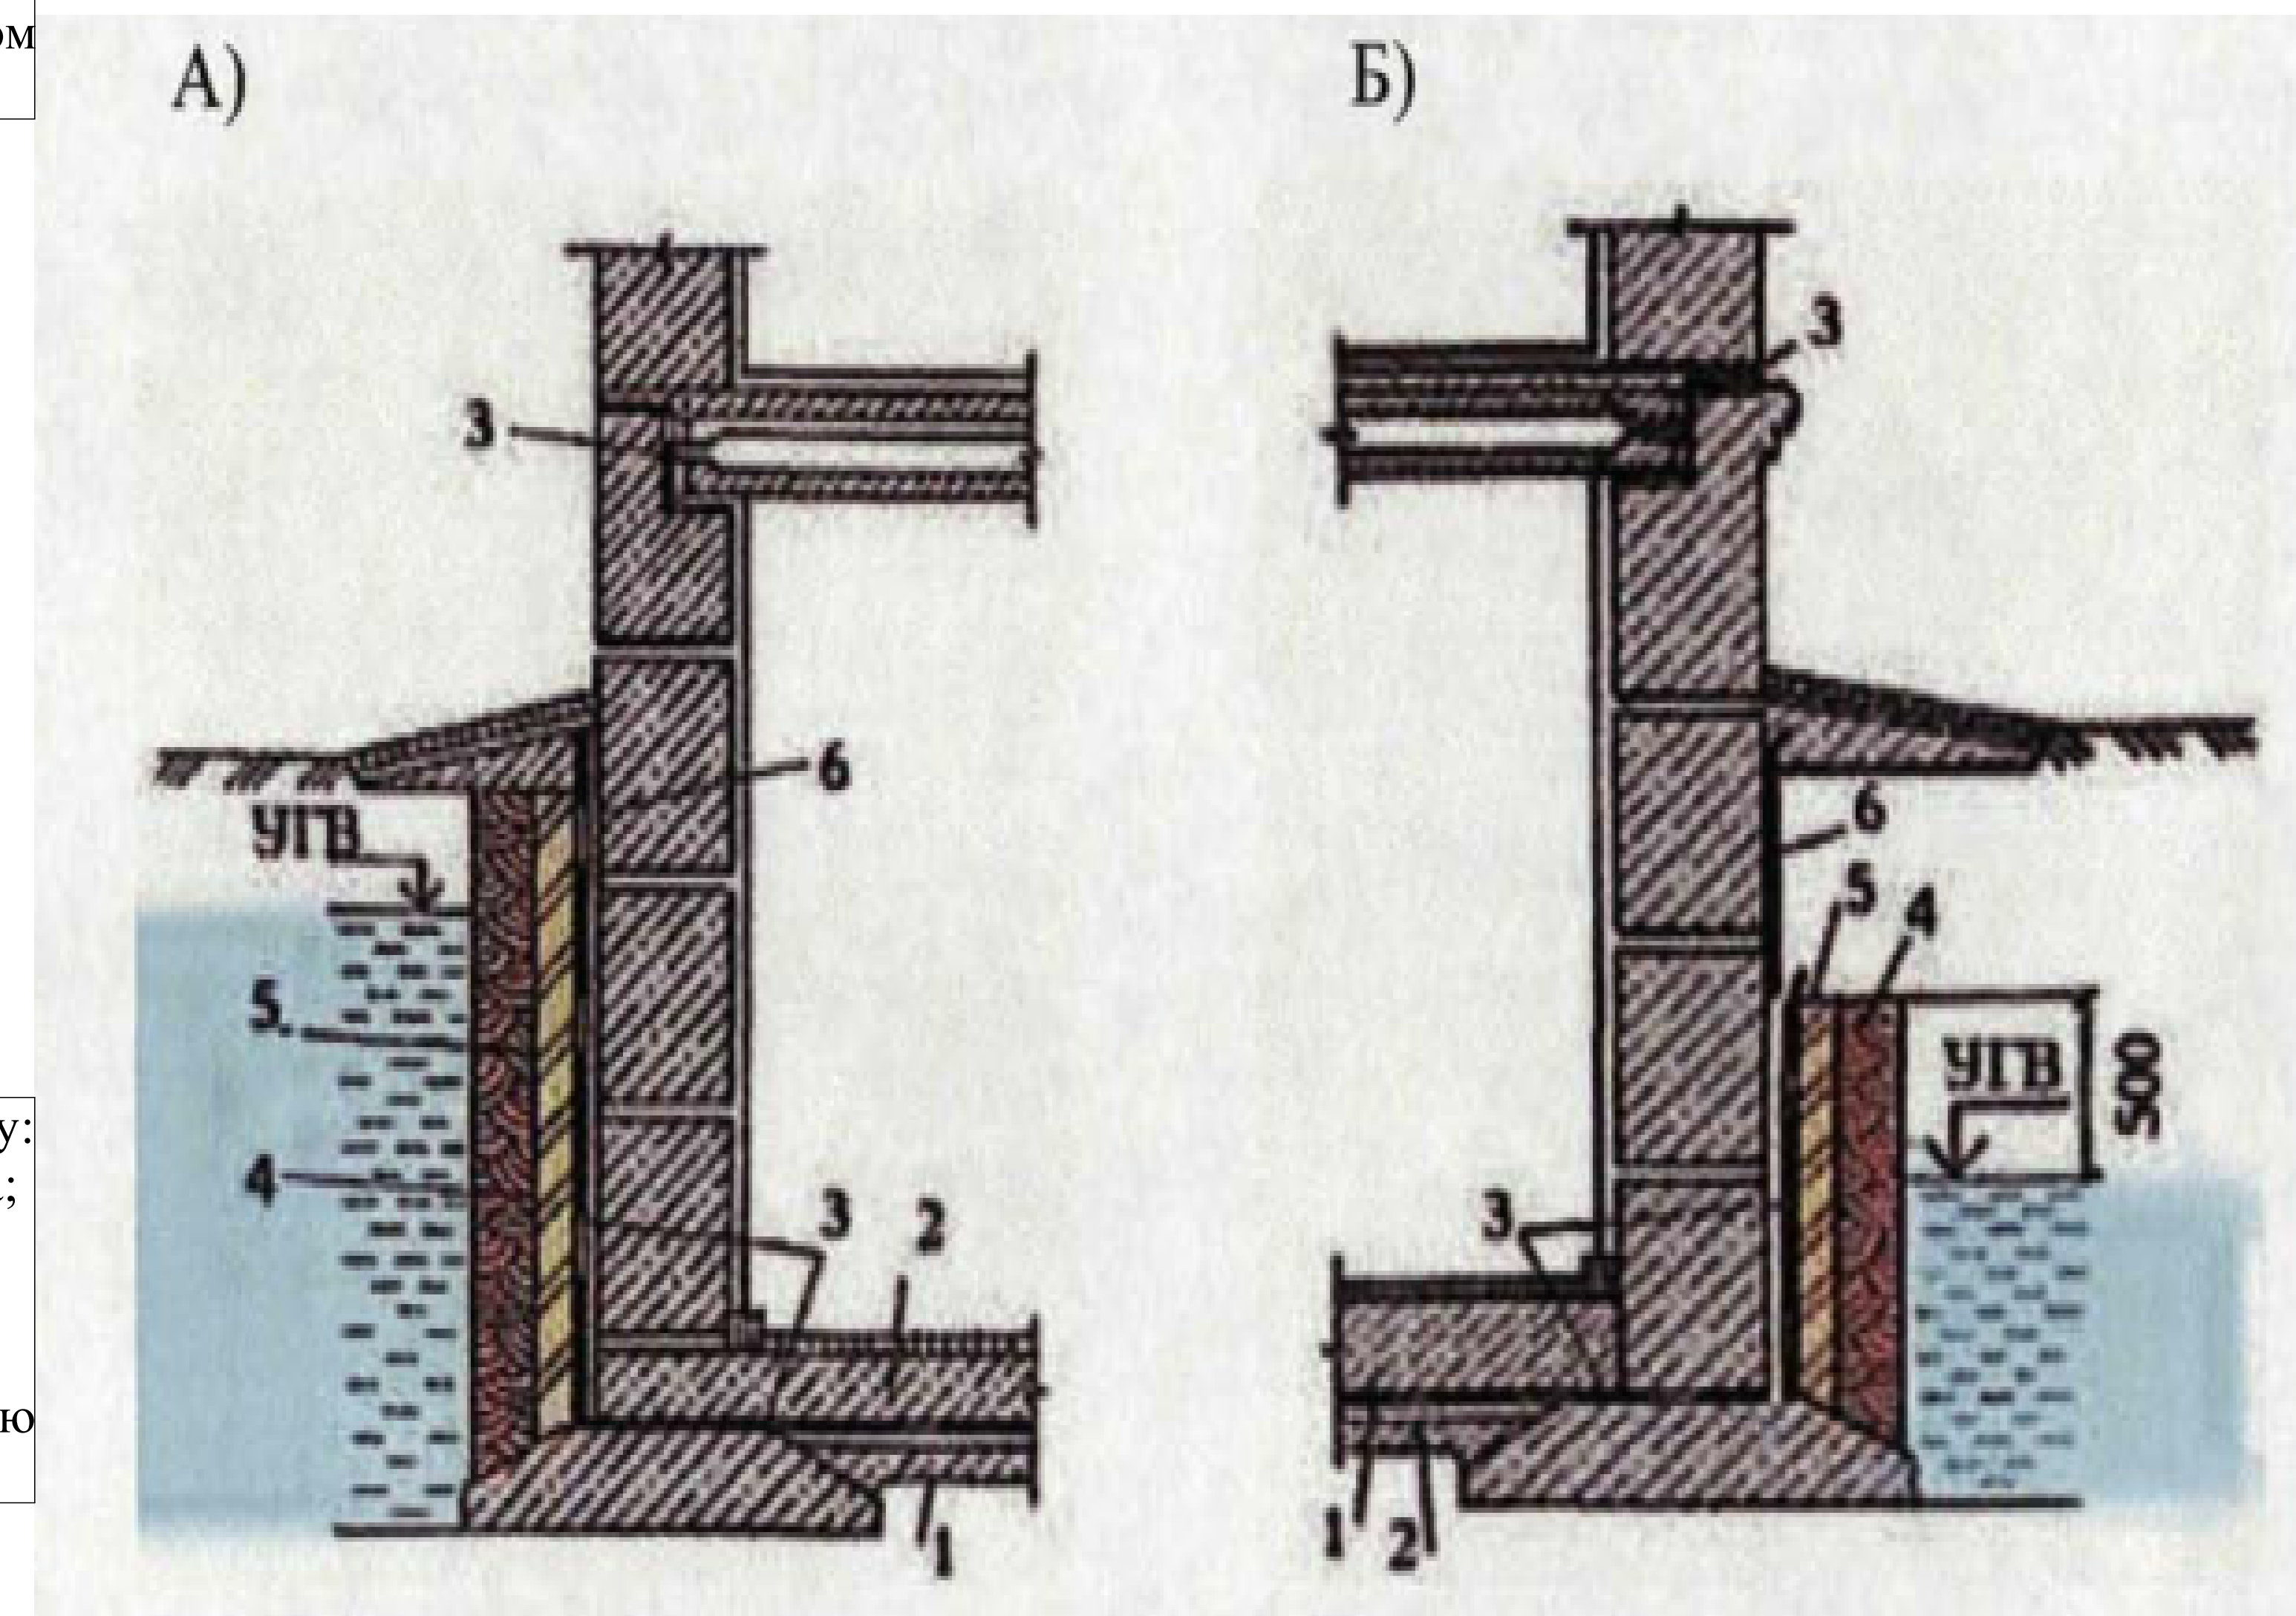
Гідроізоляція фундаменту малоповерхової будівлі.
